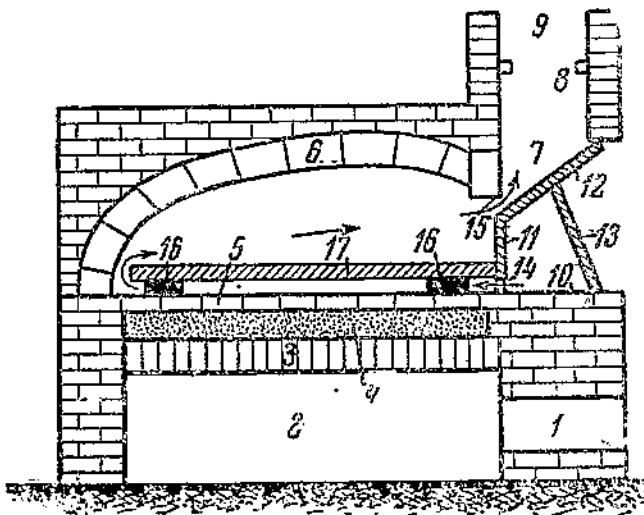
Приспособление русской печи для сушки по способу проф. Киттары:
